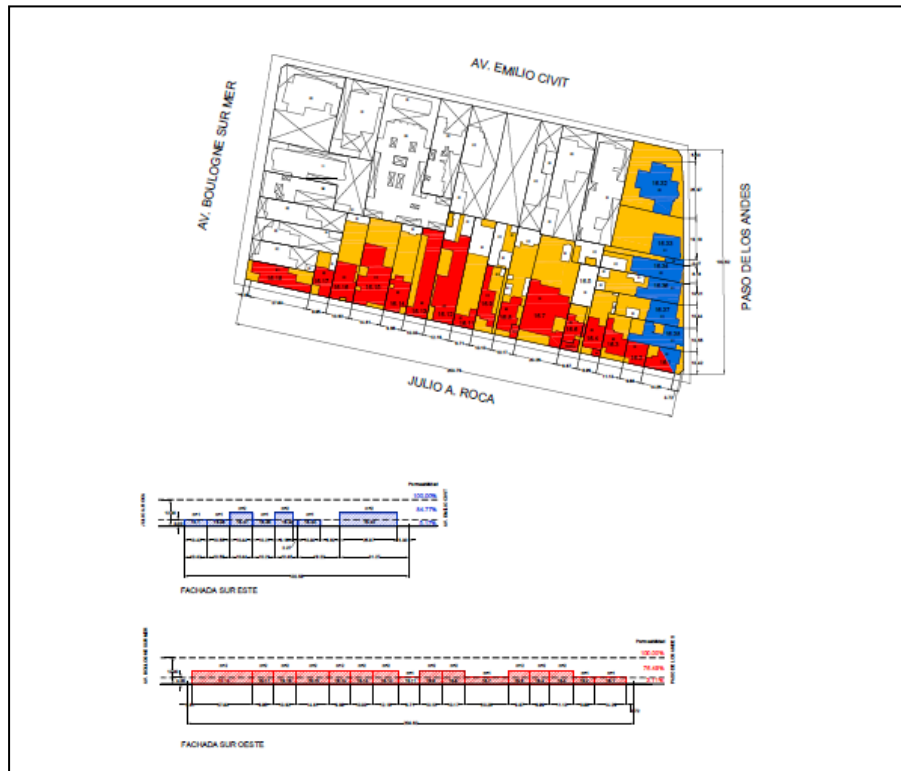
Plano de permeabilidad de fachadas – Manzana 16 – Zona E. Civit y B. Sur Mer
